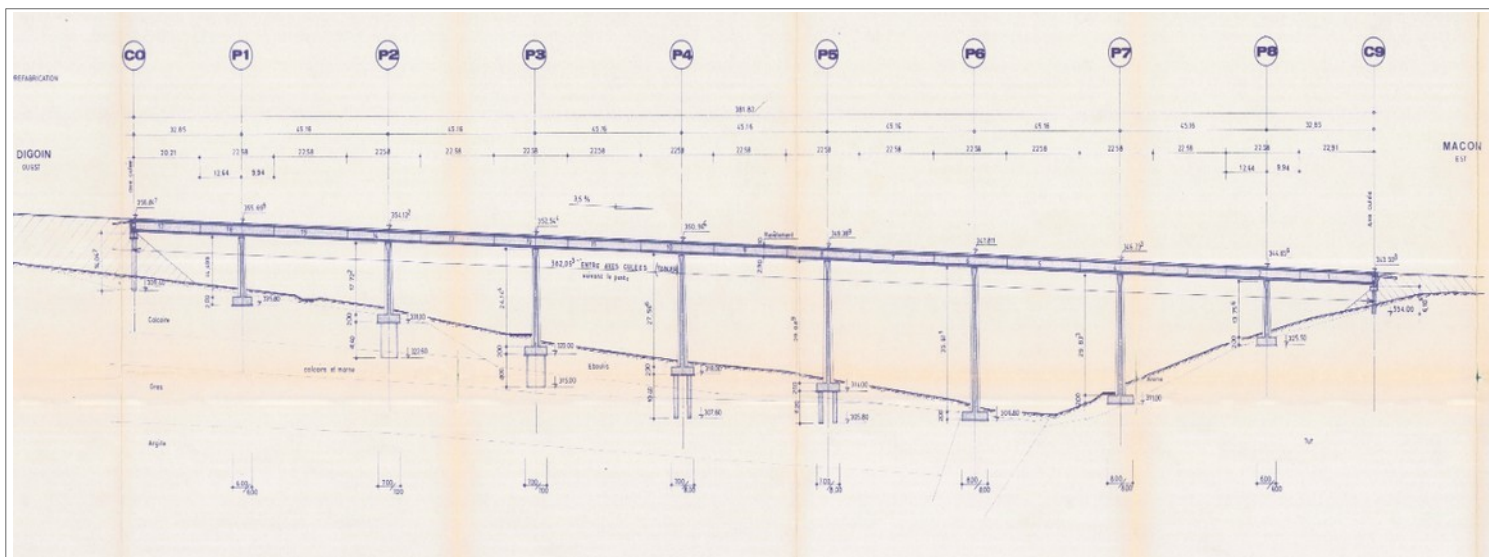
Coupe longitudinale de l'ouvrage (Archives)
